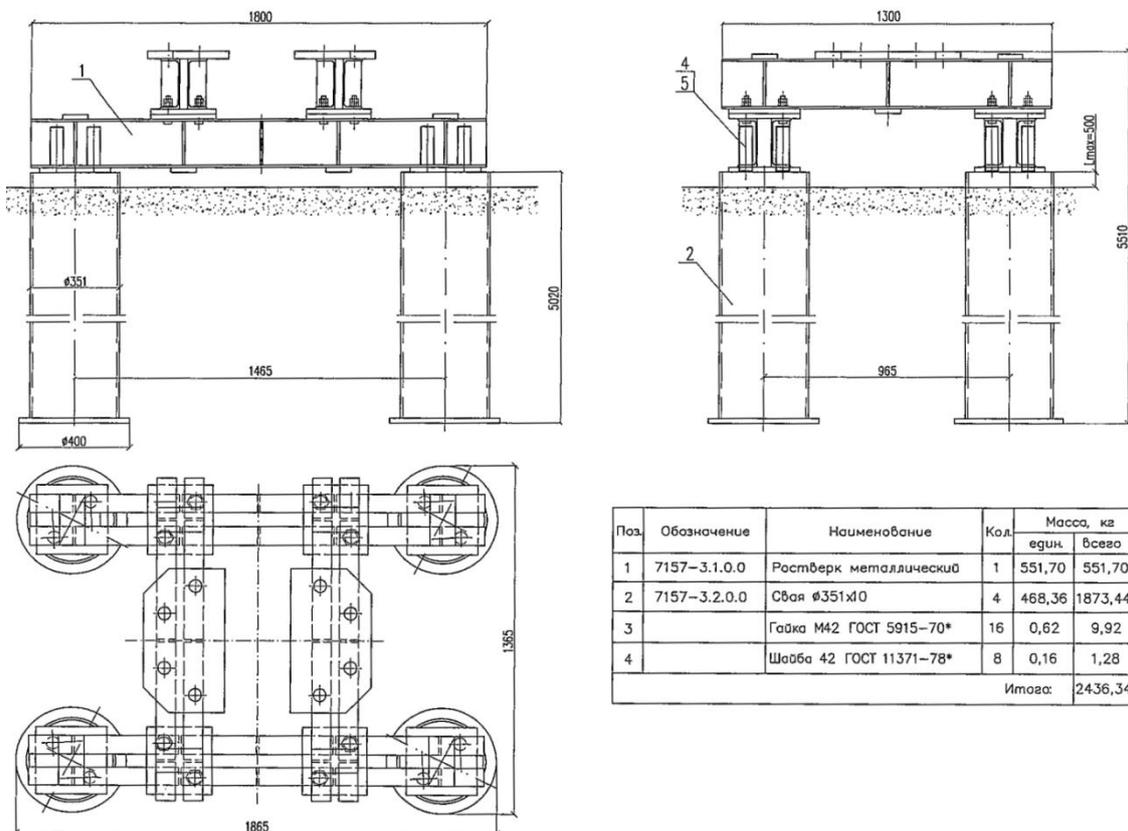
Фундамент свайный для опоры МТА-9-40
